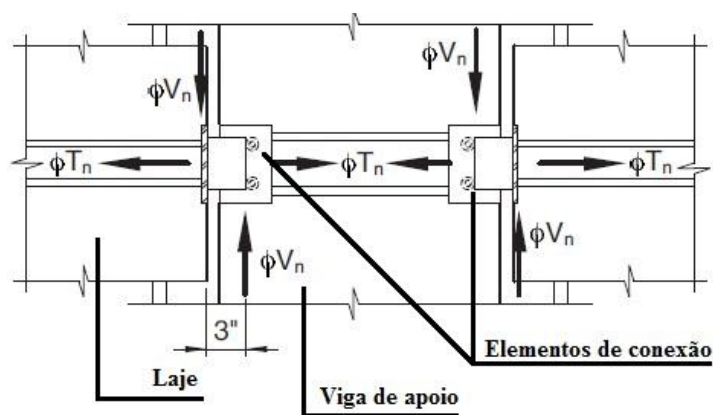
12 – Vista em planta das conexões existentes entre lajes duplo T e vigas de apoio (BASEADO EM: *Connections Manual, 2008*).
